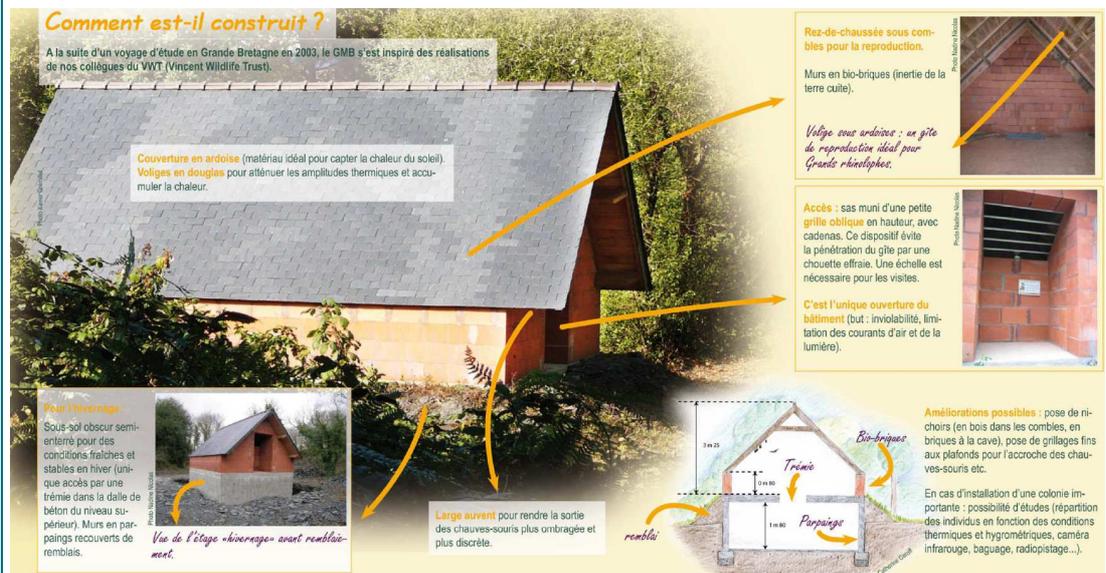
Exemple de construction réalisée (Source : Groupe mammalogique breton).
